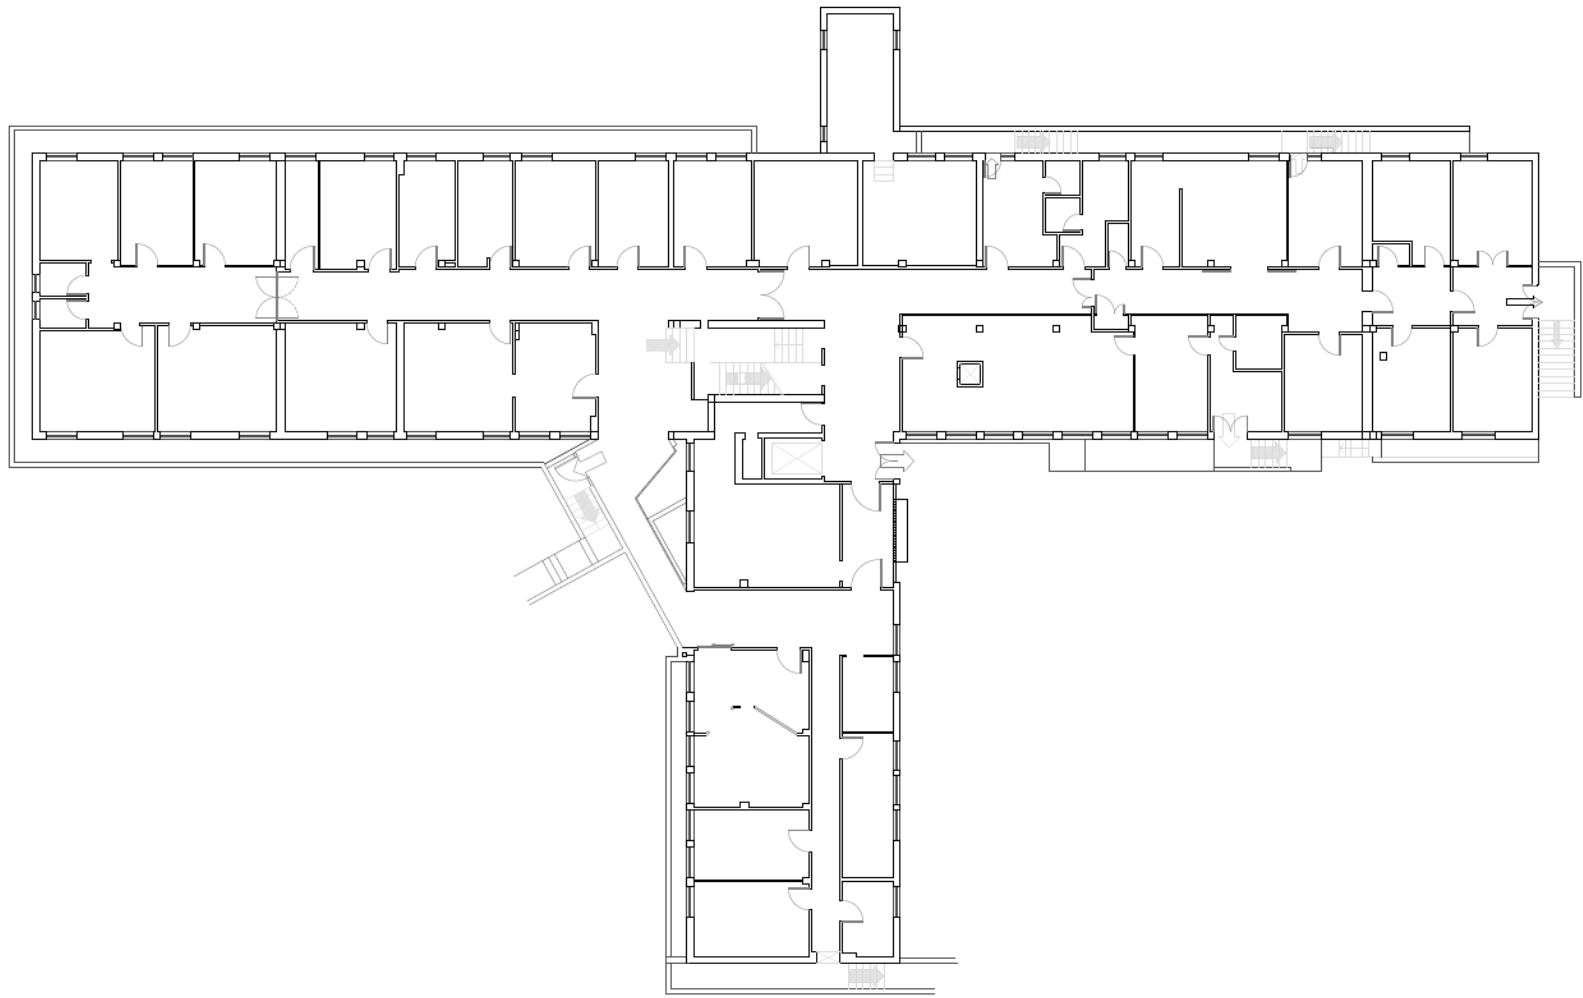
EX CLINICA BELVEDERE - PIANO SEMINTERRATO
